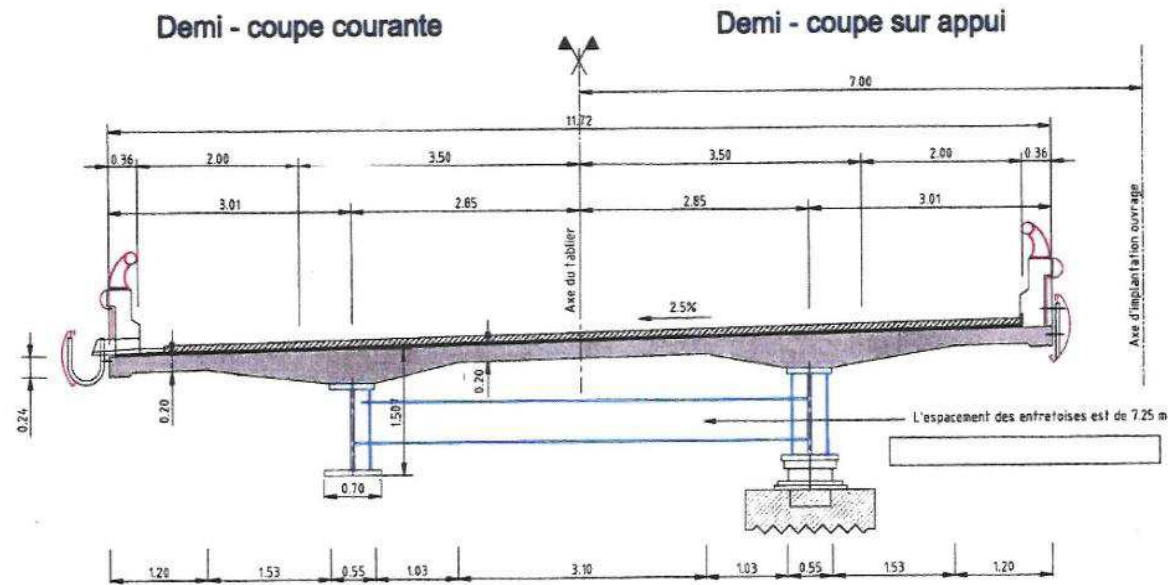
Le profil en travers du pont existant (source CEREMA)
